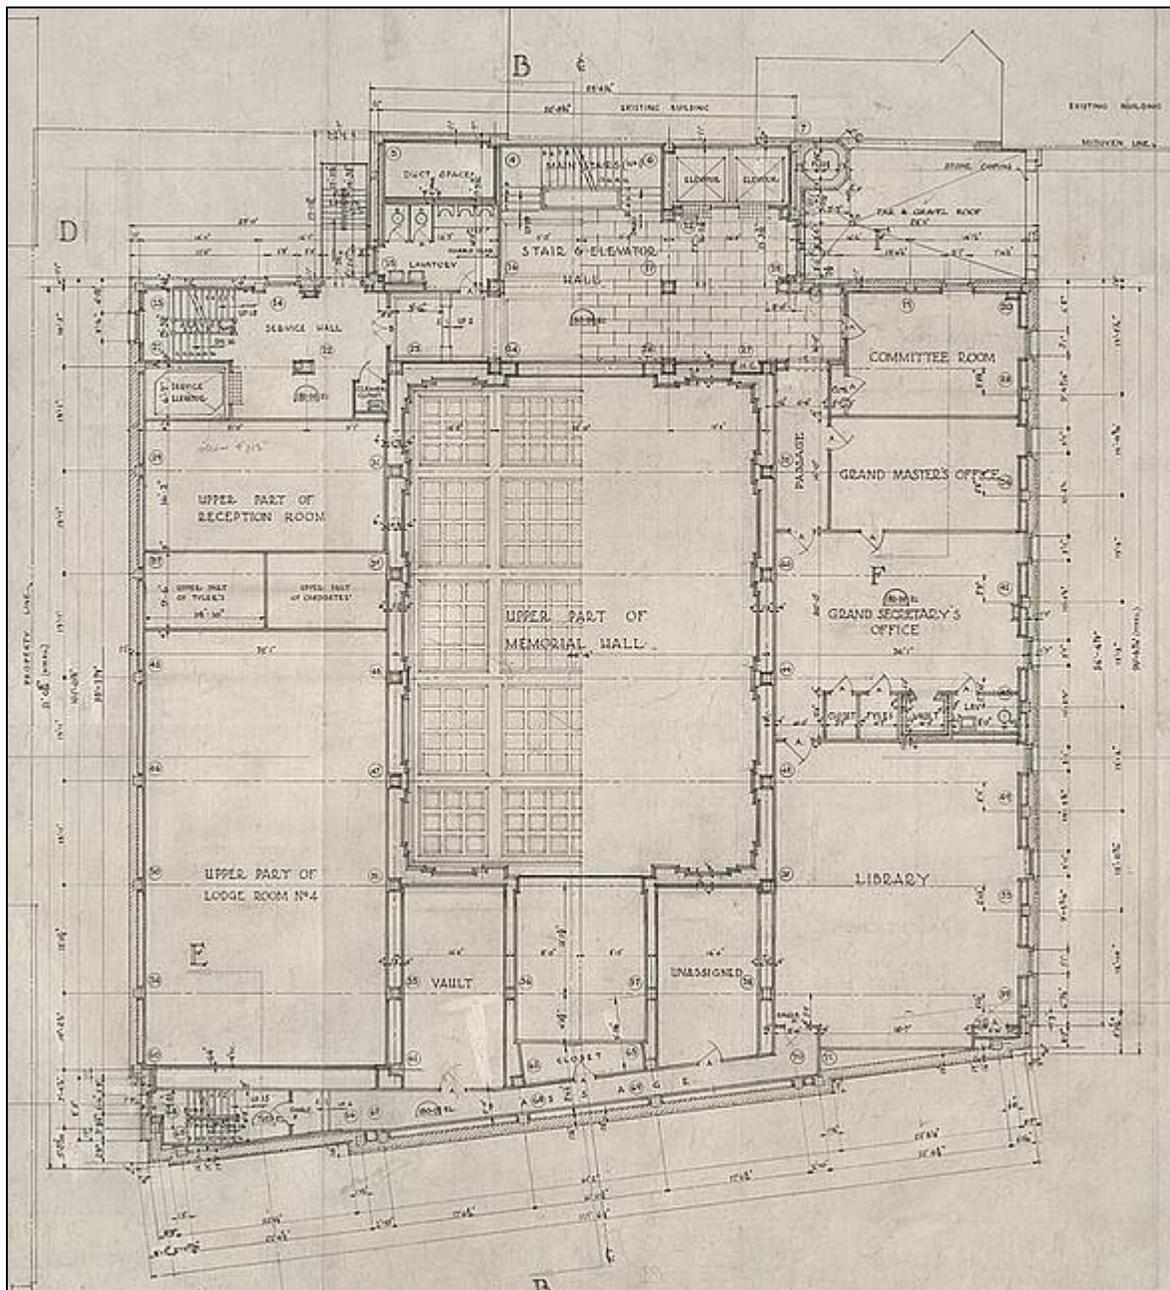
Plan du *ground floor mezzanine*, ou étage n° 4 (détail de la feuille du plan). Plans de John S. Archibald, Université McGill, collection CAC.
